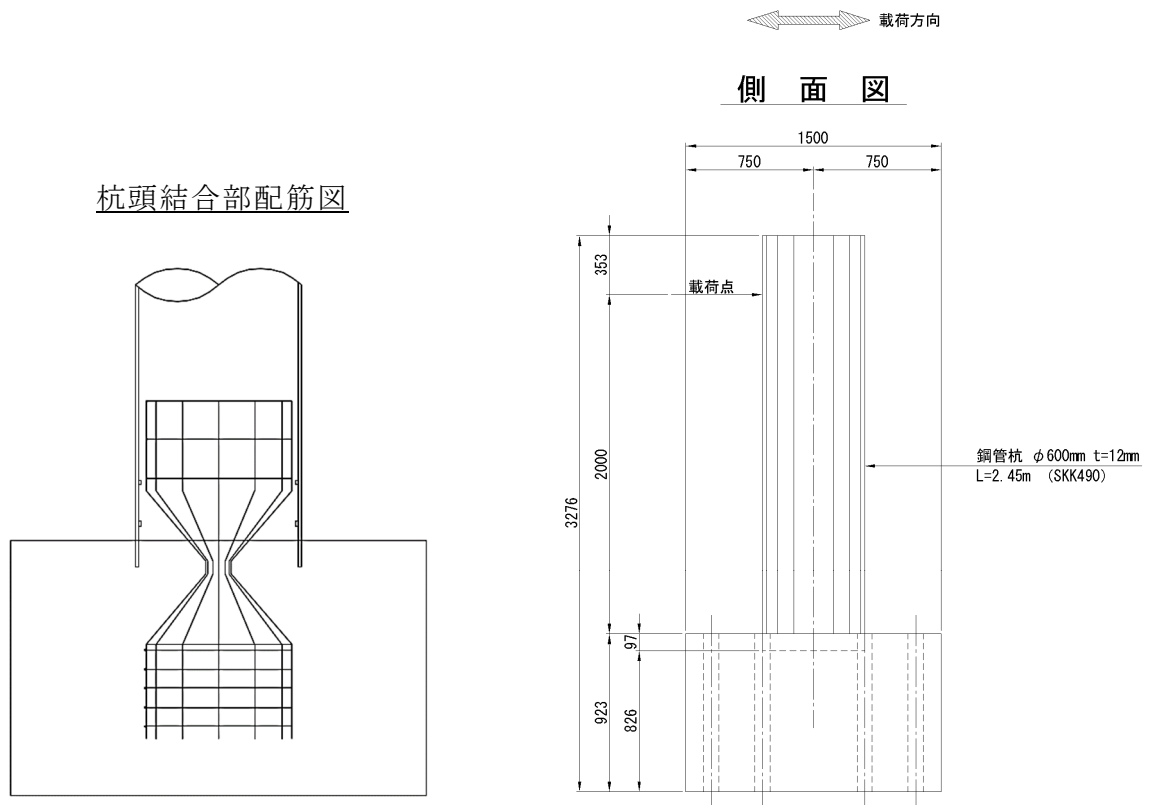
試験体構造図及び杭頭結合部配筋図
